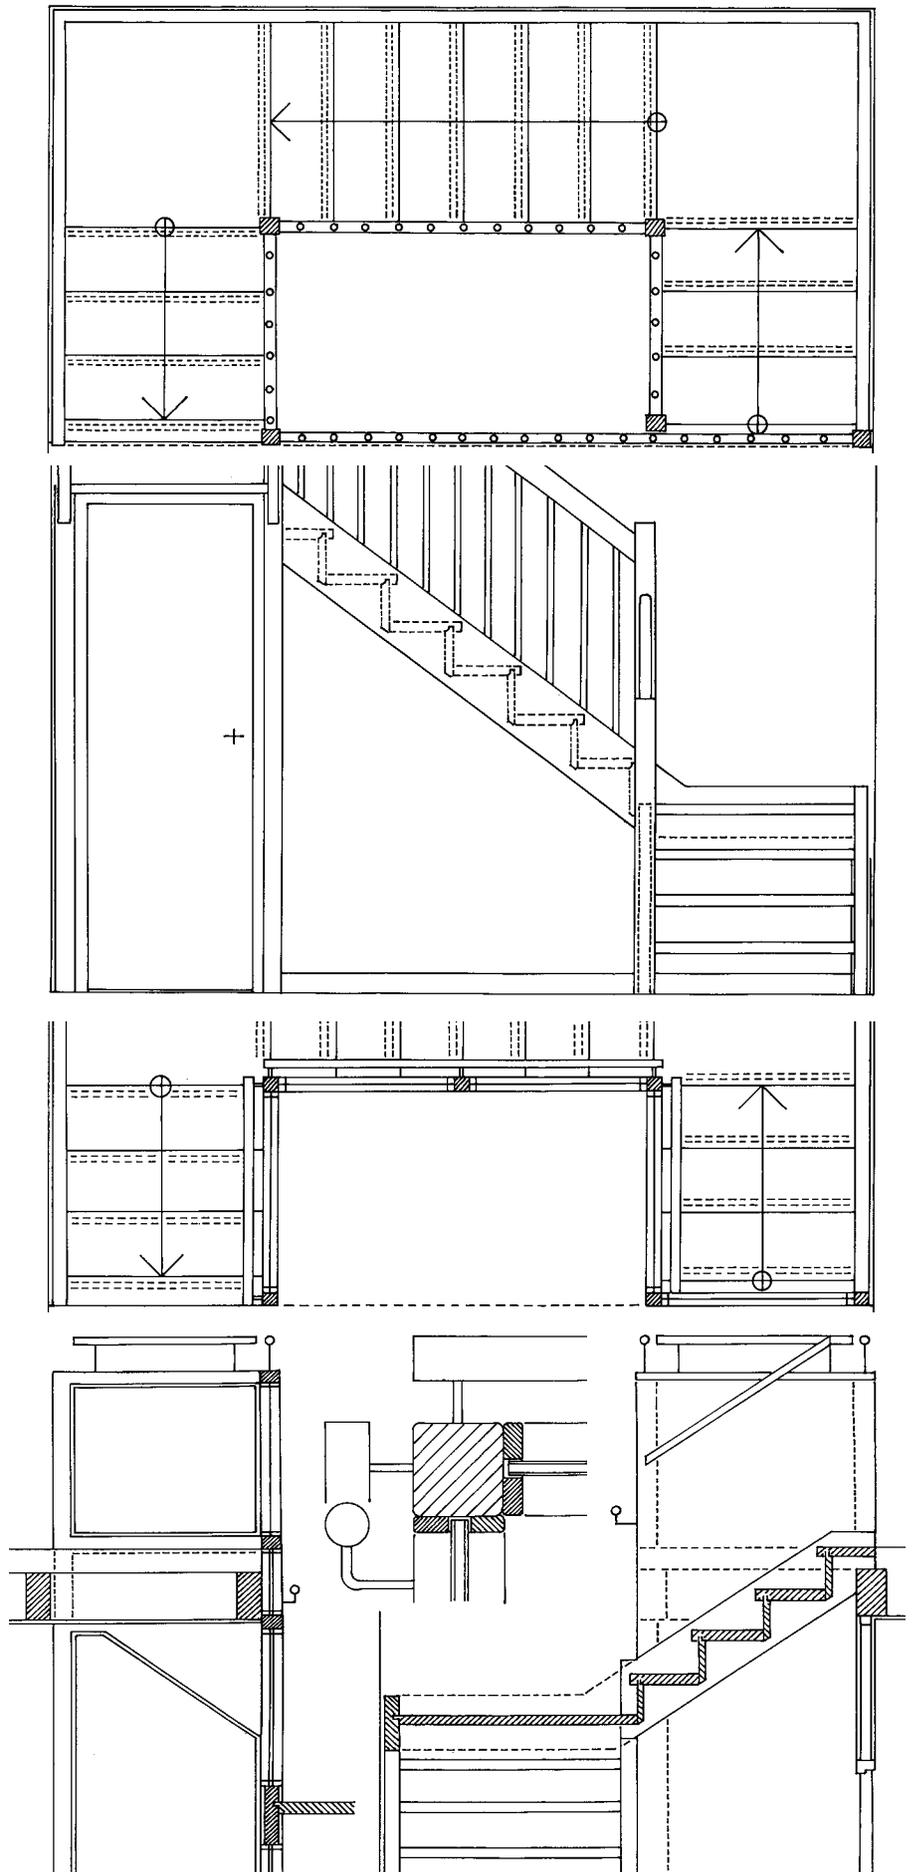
Dreiläufige Innentreppe mit Stabgeländer (oben) und mit Glasbrüstung (unten)
